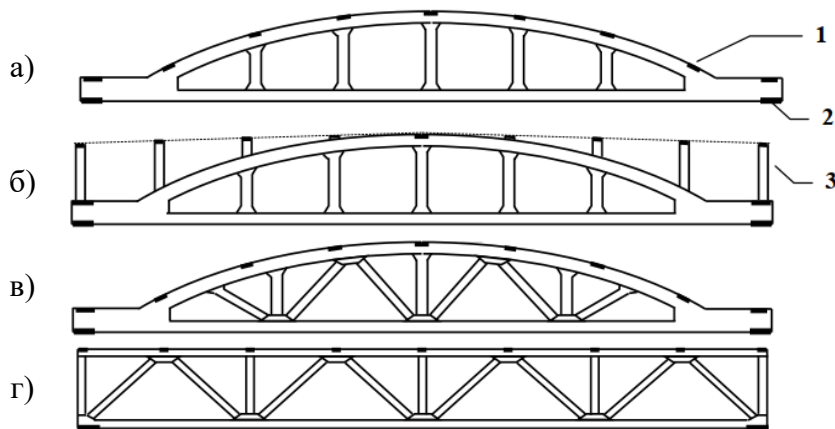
Залізобетонні кроквяні ферми: а – сегментна безроскісна; б – сегментна безроскісна малоухильна; в – сегментна розкісна; г – з паралельними поясами; 1 – закладні деталі; 2 – опорна плита; 3 – надопорний стояк
